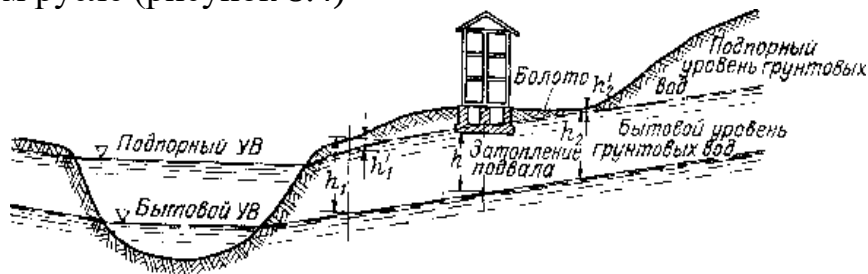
Схема подъема уровня грунтовых вод и подтопления земель
